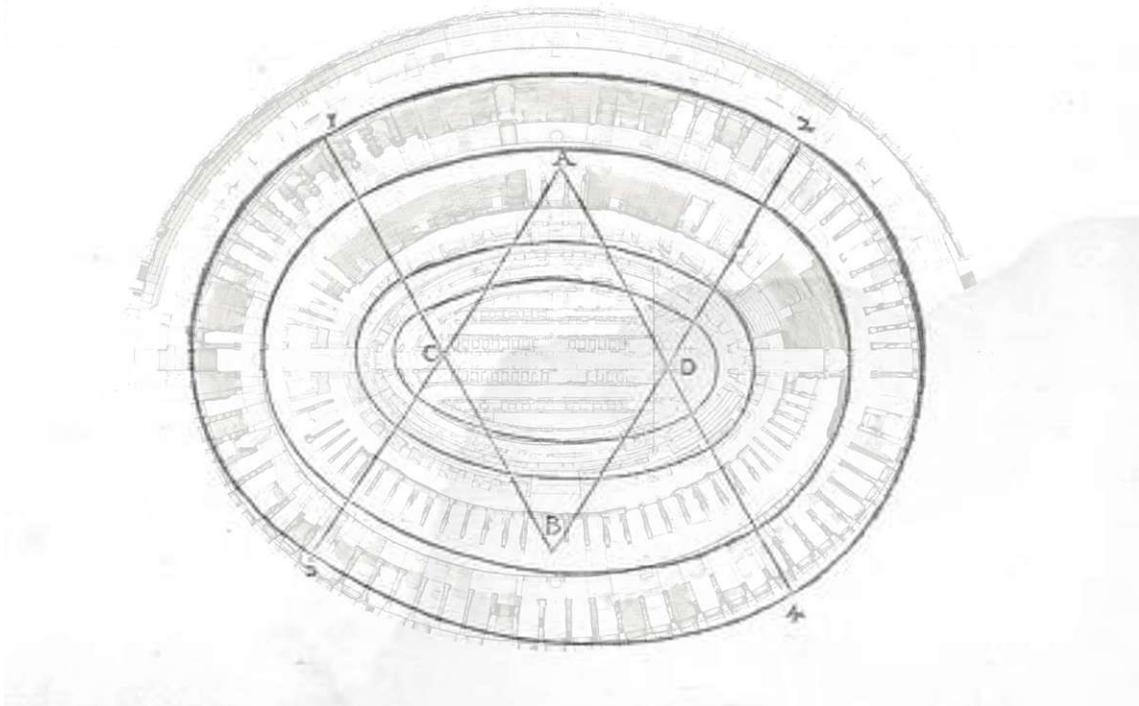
Überlagerung von Sebastiano Serlios Konstruktionsweise und dem tatsächlichen Grundriss des Kolosseums⁶⁴
